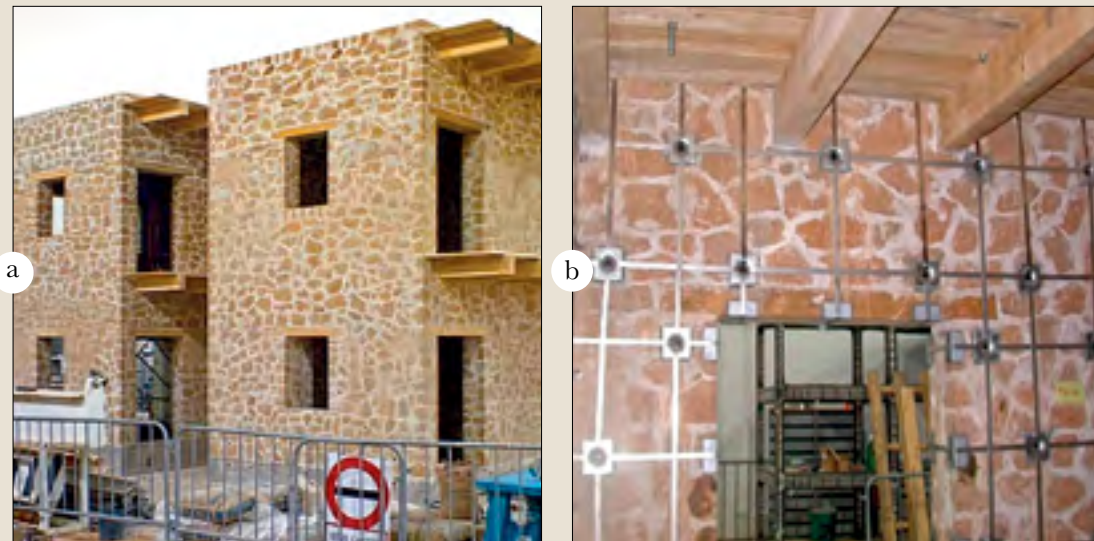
Progetto TREMA: a) Struttura dell'edificio di prova; b) Struttura rinforzata con il sistema di confinamento attivo della Muratura.
